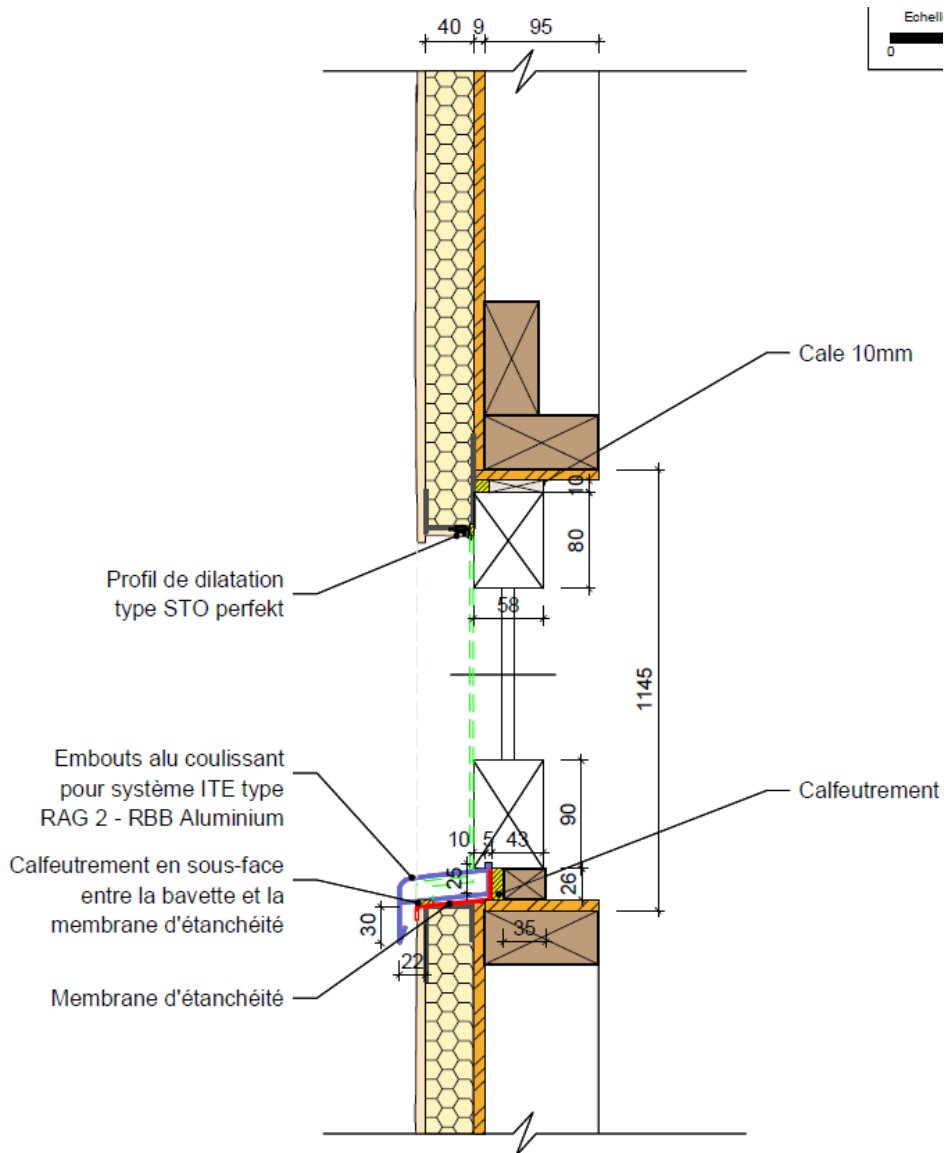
Maquette avec menuiserie en tunnel extérieur – coupe verticale
